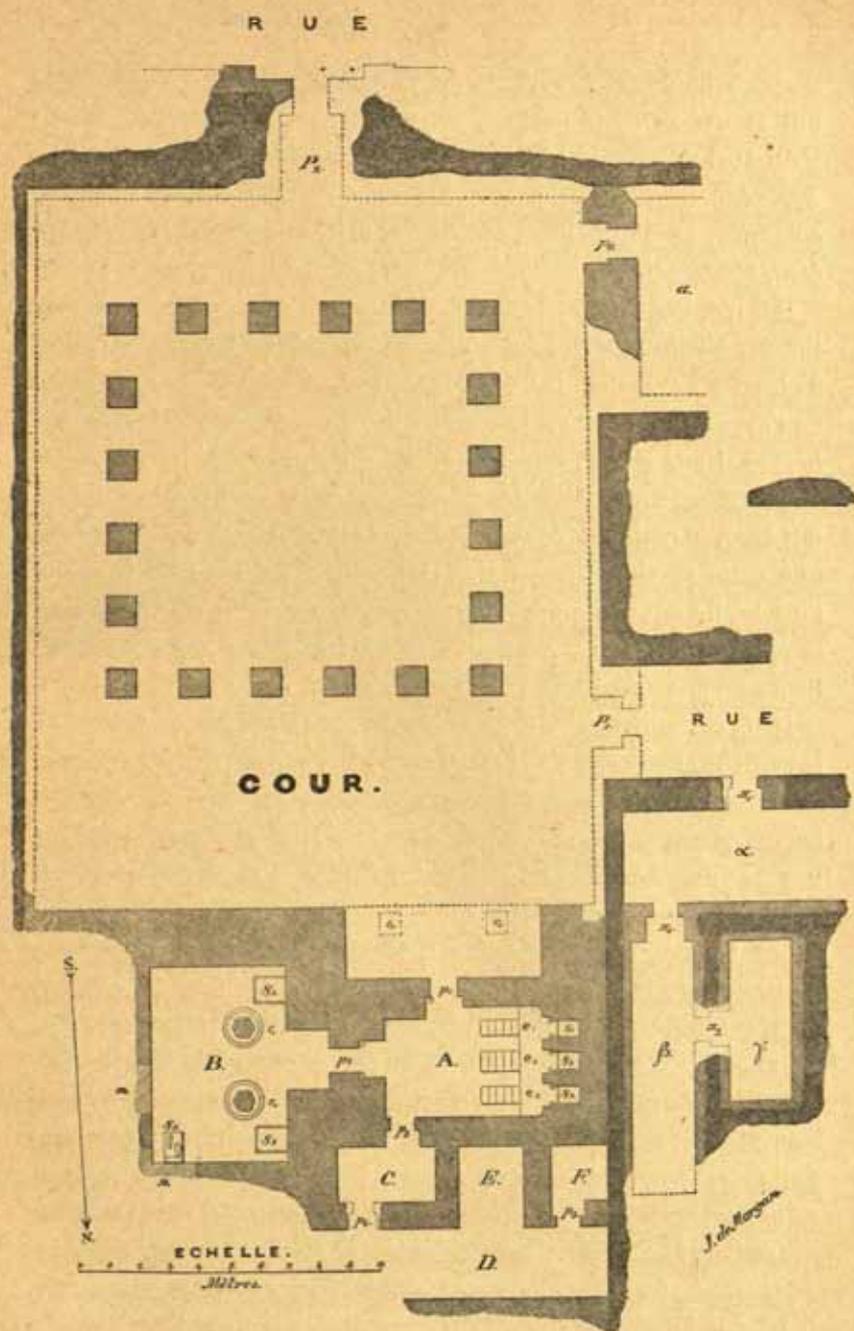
Plan du mastaba de Ptah-Chepsès.
